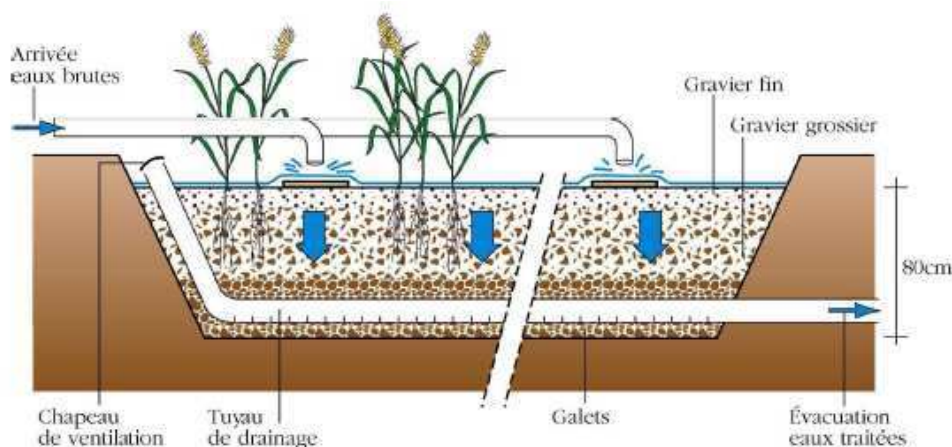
Vue en coupe d'un « Lits plantés de roseaux »
